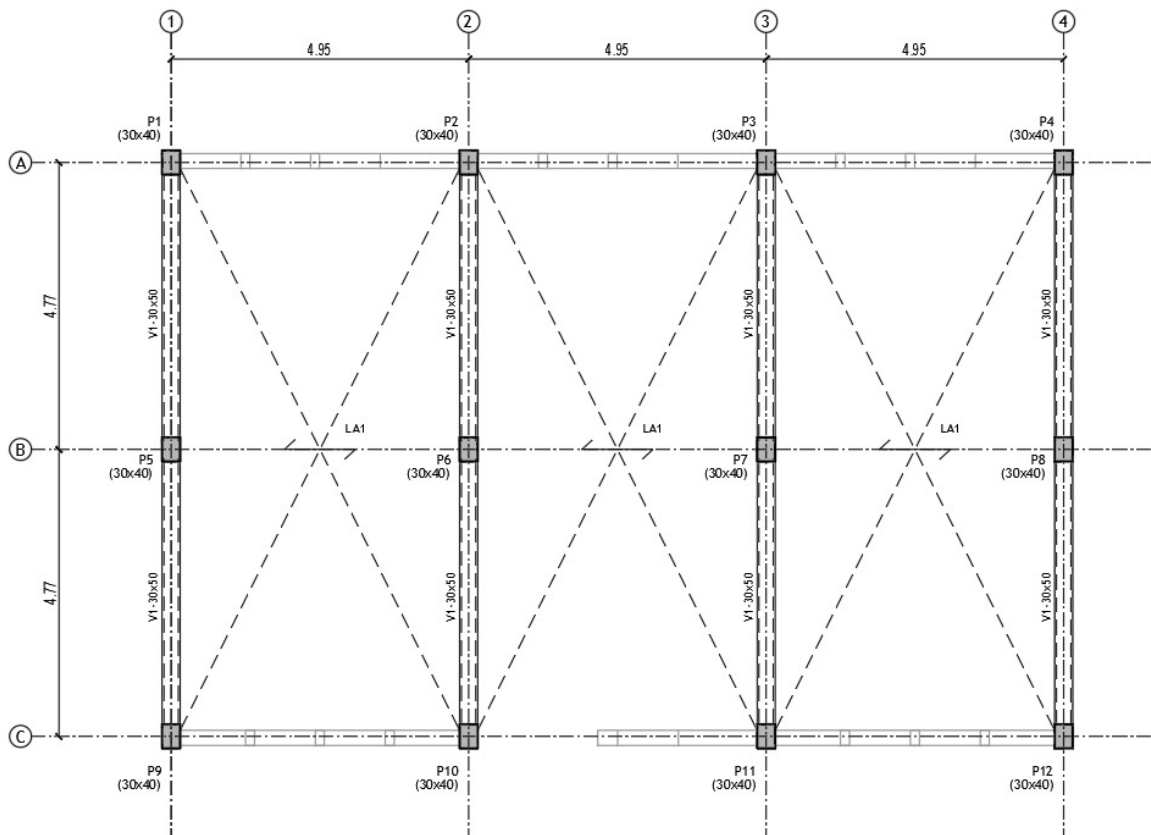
Identificação dos pilares e vigas e da orientação das lajes no piso 1
